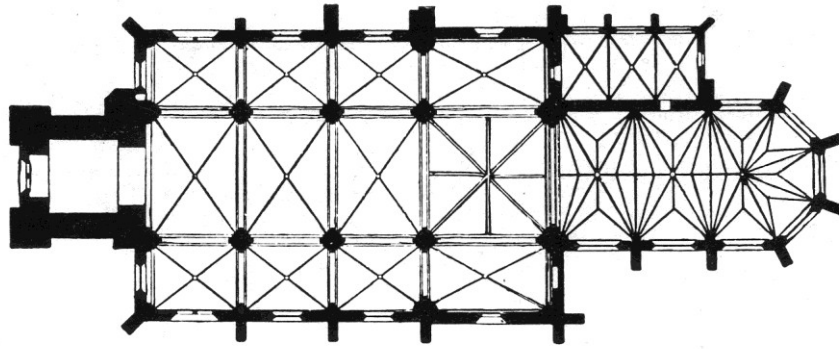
Dortmund, St. Reinoldikirche, Grundriss nach dem Wiederaufbau nach 1945
